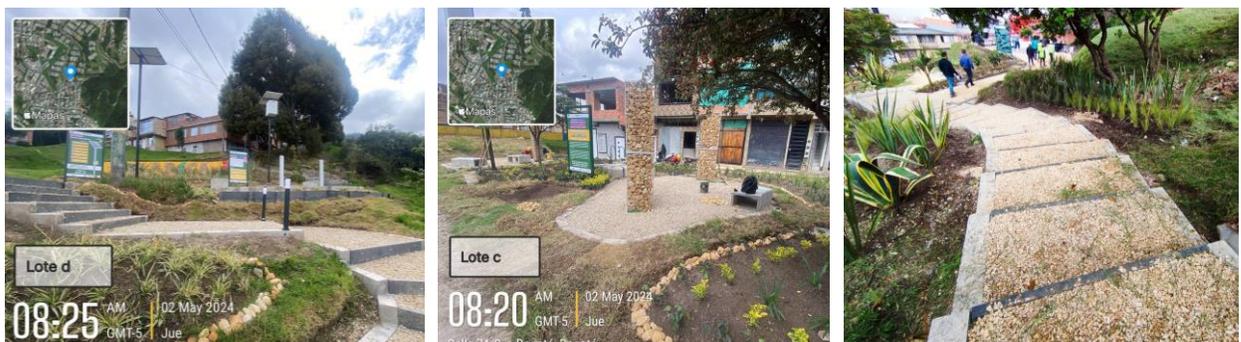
Proyecto de Infraestructura Eco Barrios Valles de Cafam
